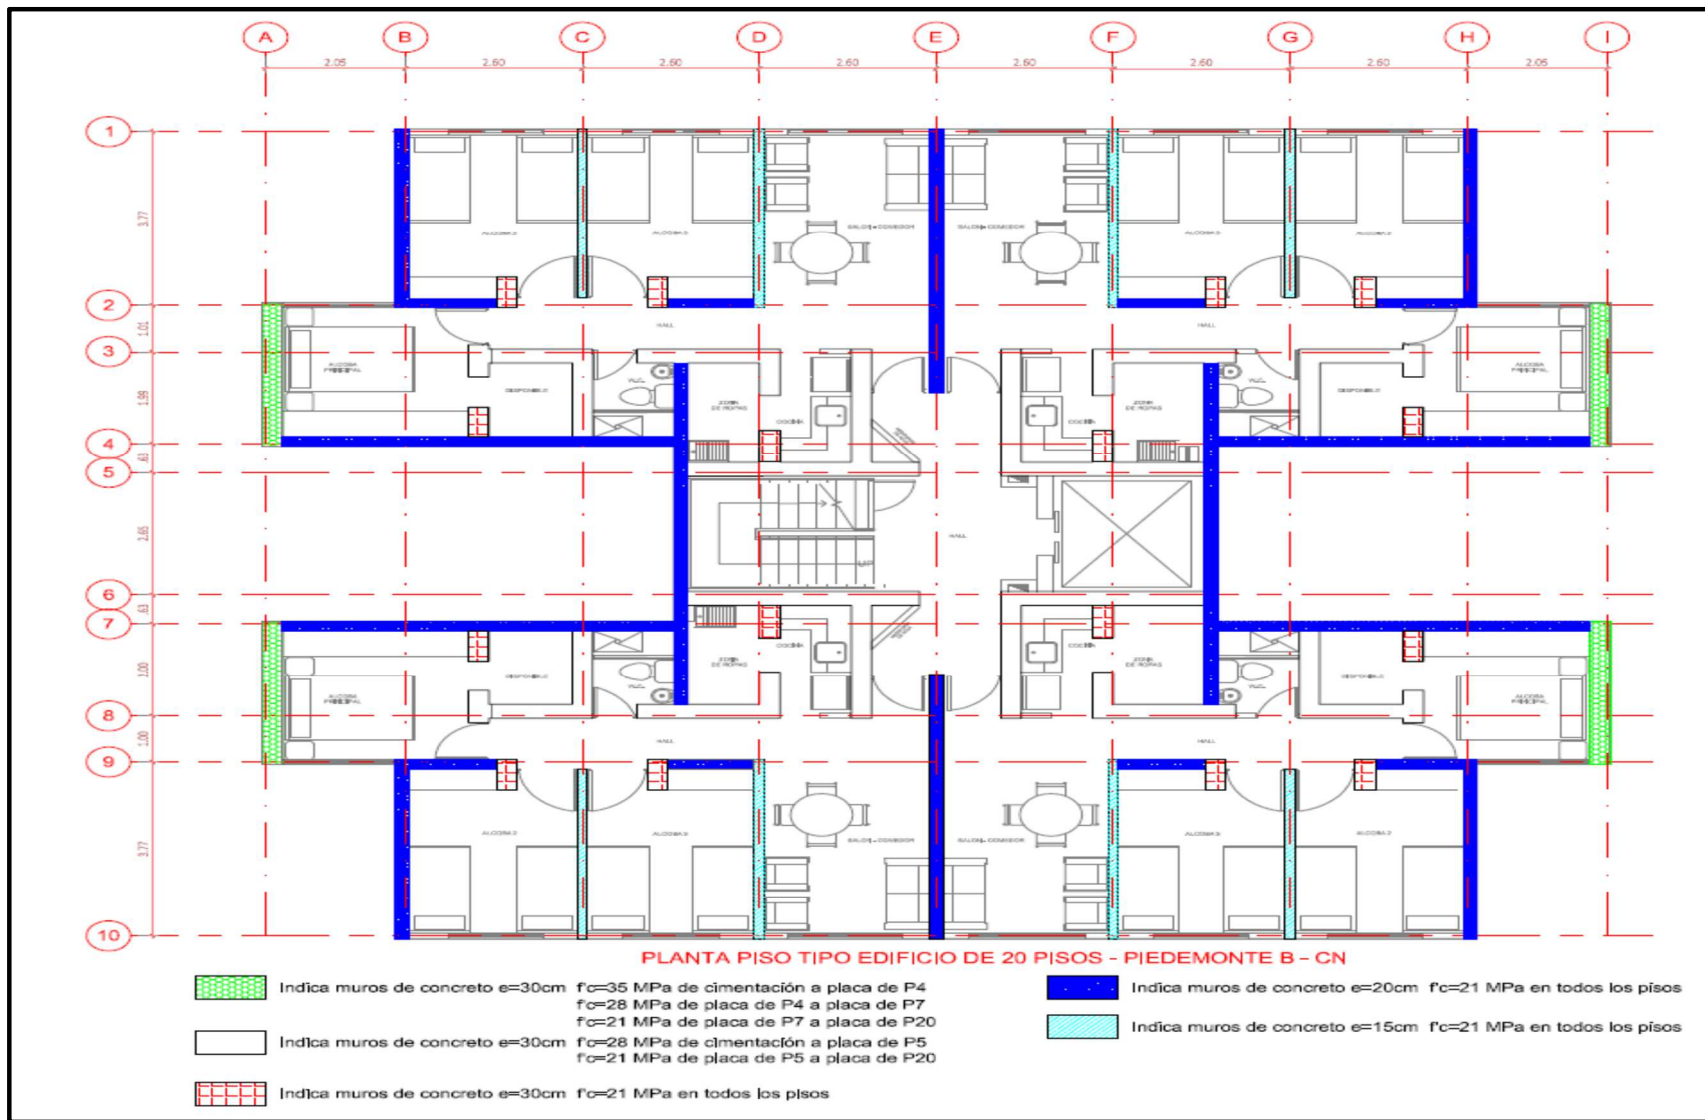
Planta piso tipo edificio de veinte pisos – Piedemonte B-CN. Elaborada por la autora
